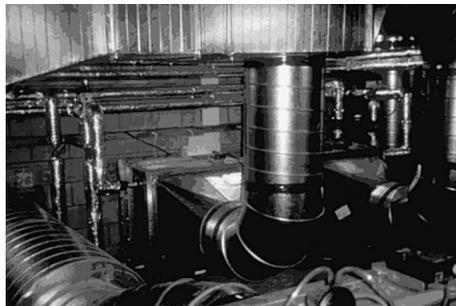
L'encombrement des conduits d'air ne facilite pas la maintenance
